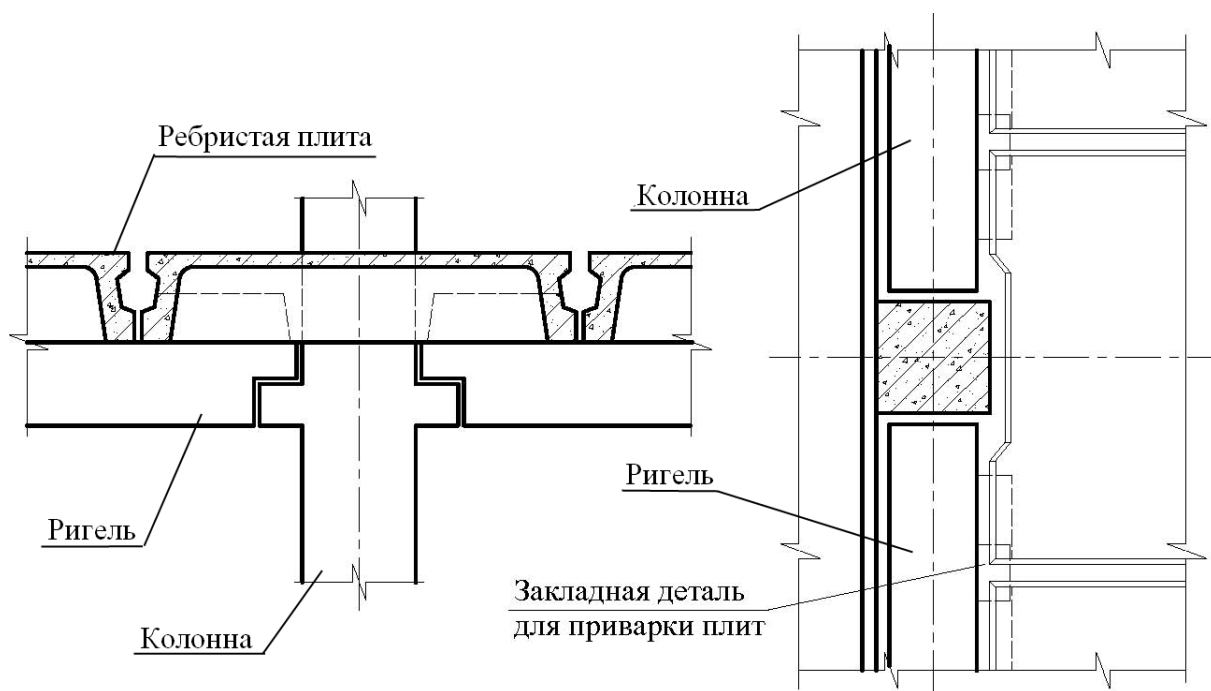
Схема опирания ребристого перекрытия на сборный ригель по серии 1.042.1-5.94 [5]
